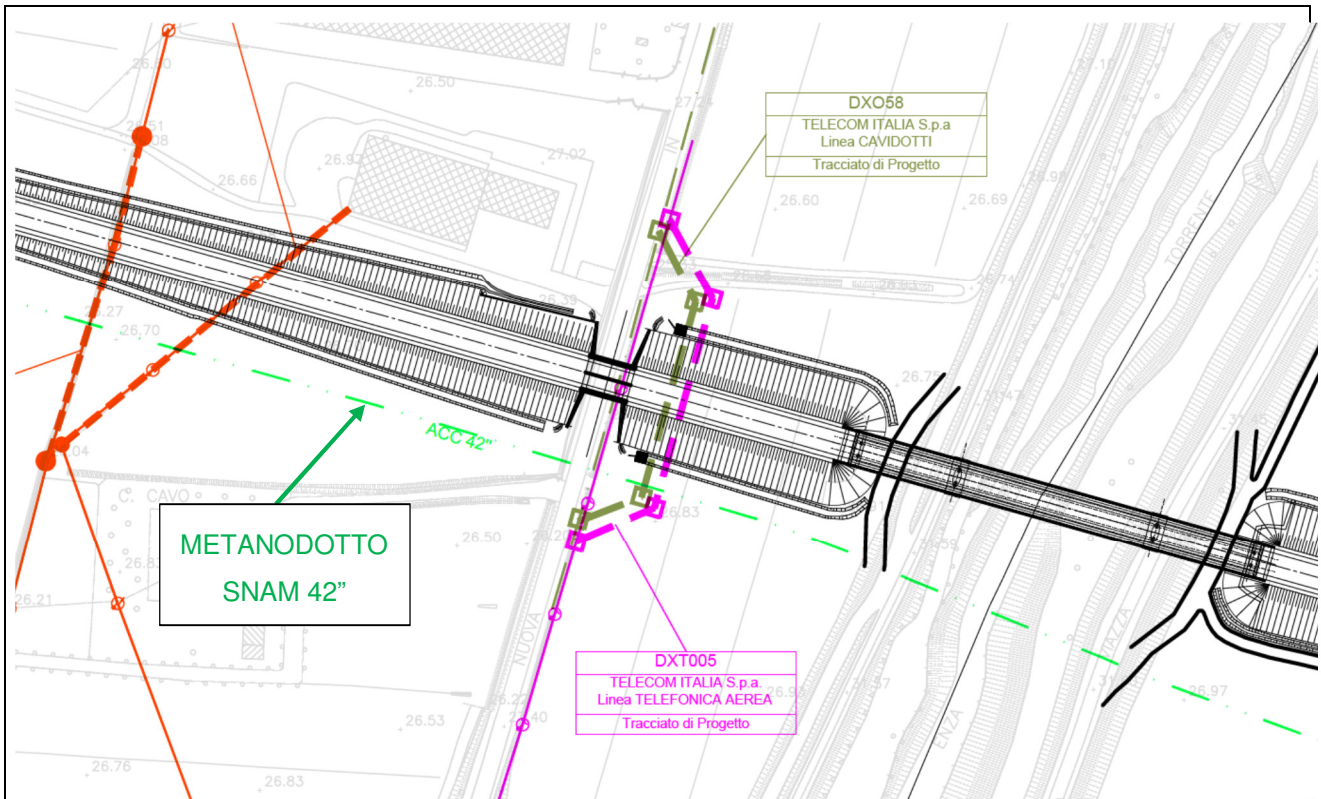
ESTRATTO PLANIMETRIA CON INTERFERENZE SOTTOSERVIZI
